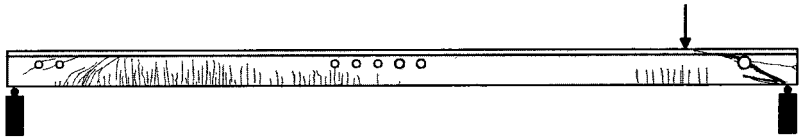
Rissbild Balken G16 nach dem anschließenden Torsionsversuch
